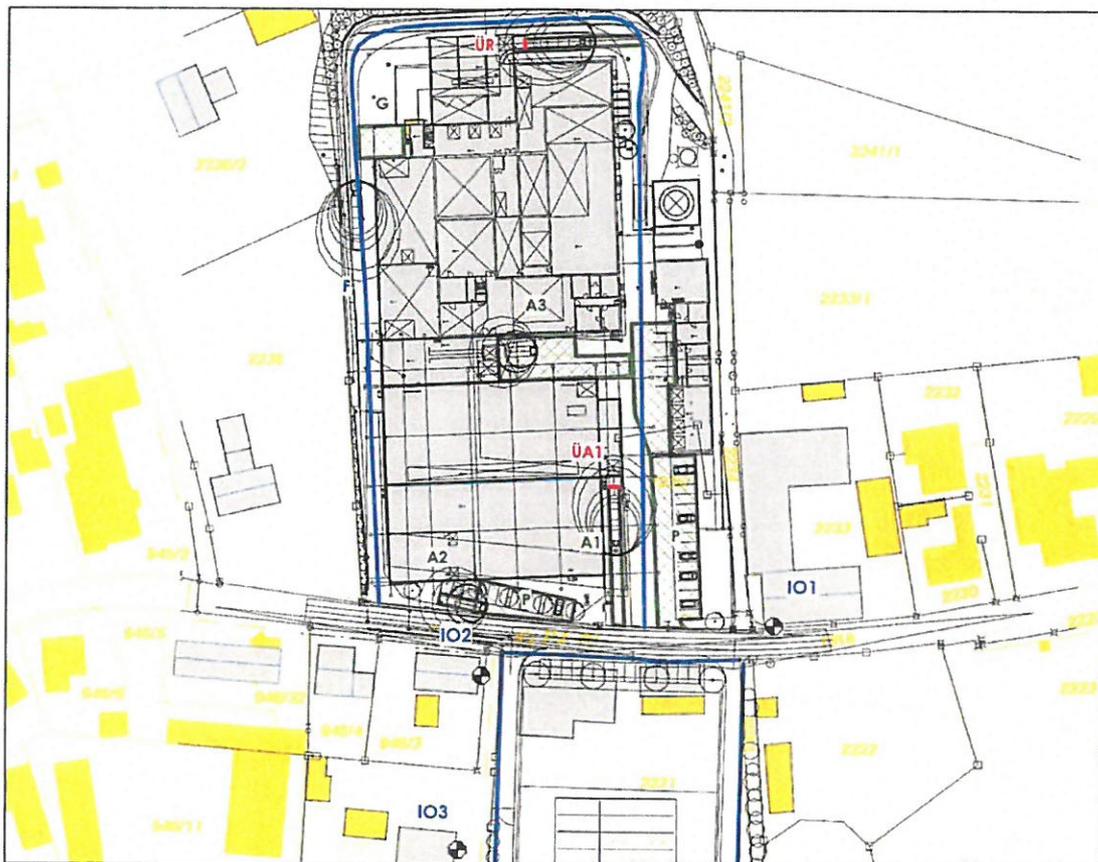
Lageplan mit Darstellung der relevanten Schallquellen für den bestehenden Betrieb sowie der für die Geräuschkontingentierung maßgeblichen Immissionsorte
